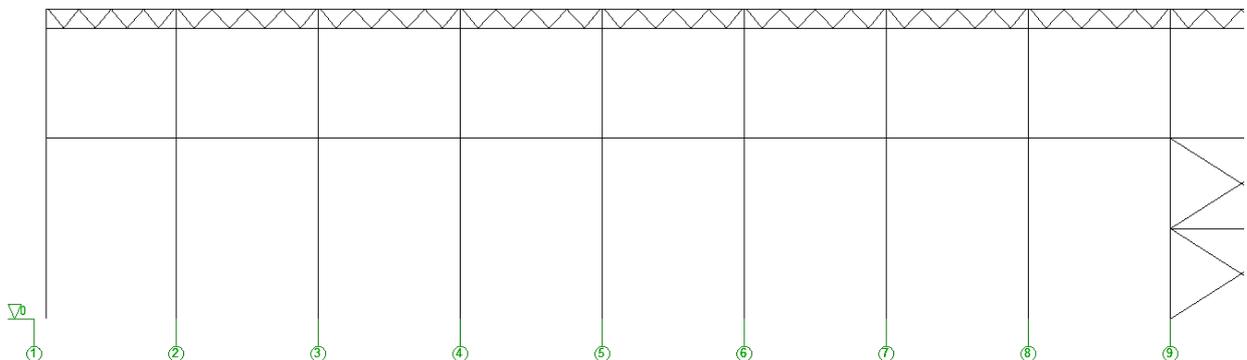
Симметричный фрагмент подстропильных ферм между колоннами среднего ряда
